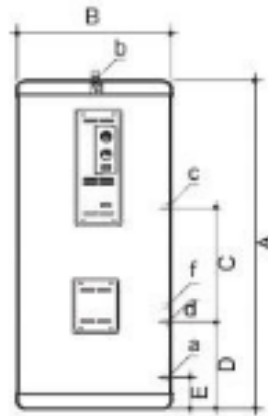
Alzado de la colocación del módulo interior en el garaje.
